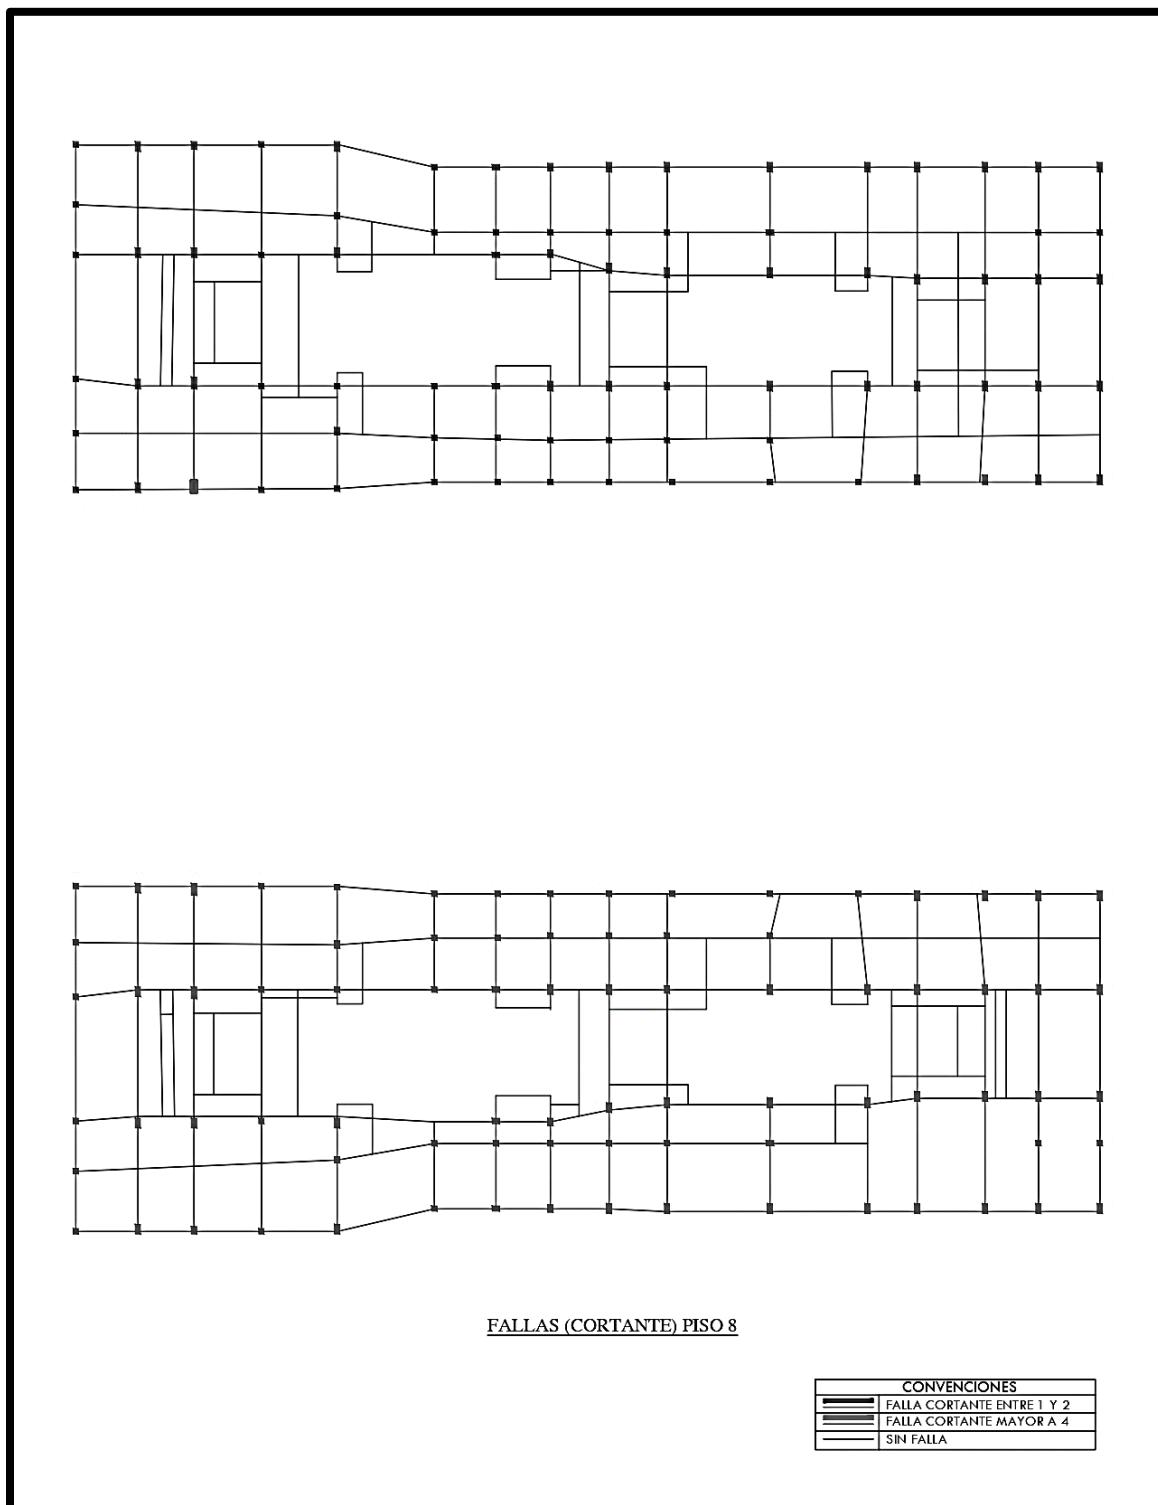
Plano se secuencia de fallas (Cortante) nivel 8. Fuente: Los autores
